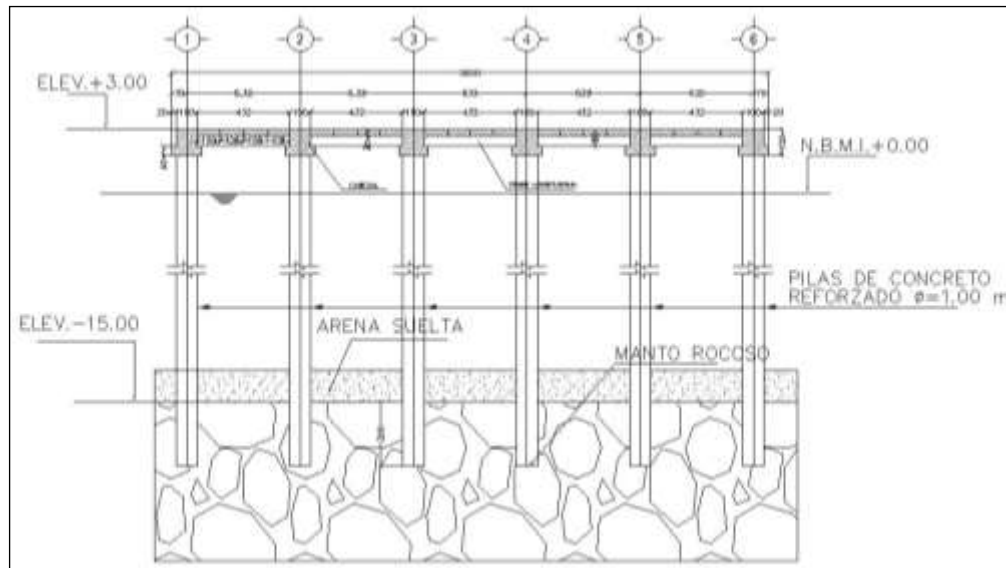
Elevación transversal, estructura tipo del muelle.
